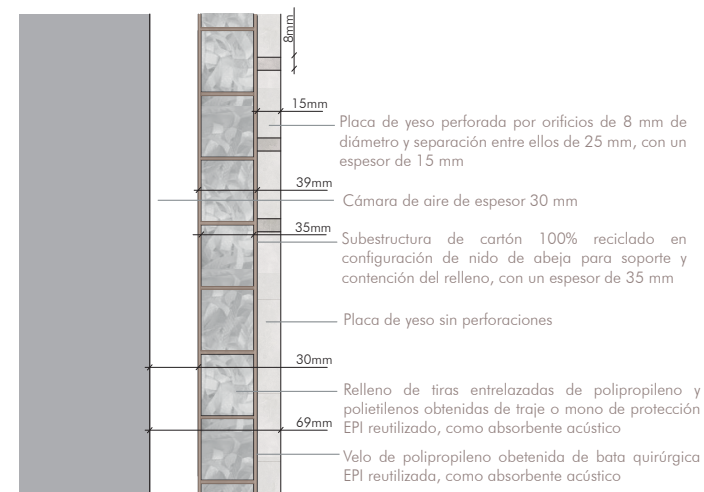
Detalle constructivo tipo del trasdosado propuesto, encuentro entre el panel de yeso con y sin perforaciones. Fuente: elaboración propia
